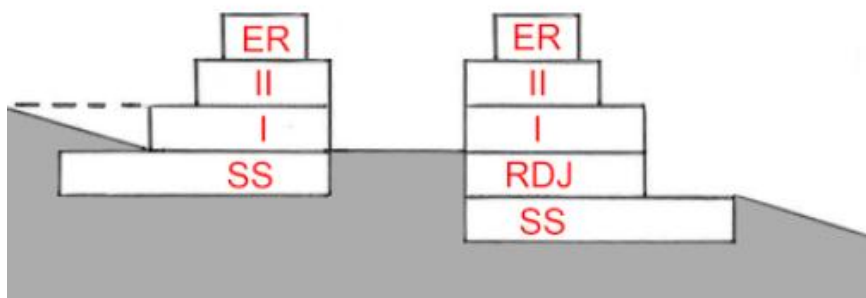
Constructions sur terrain en forte pente avec un rez-de-jardin.
